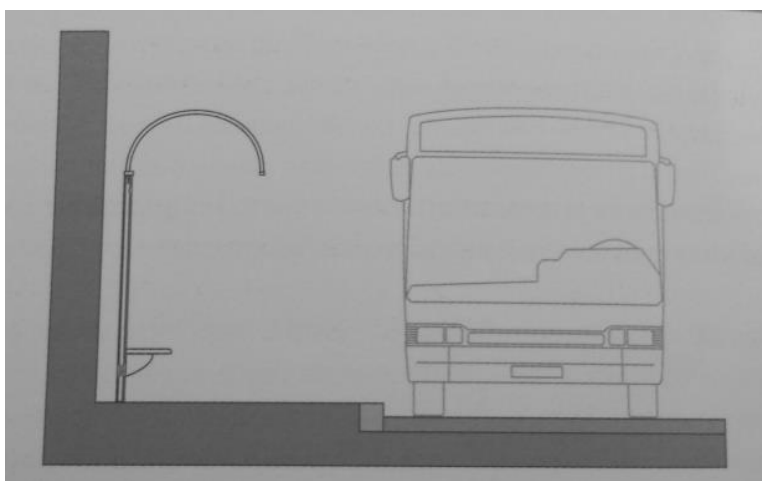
Esquema dimensionado de Parada tipo Marquesina (Dimensiones en mm).
